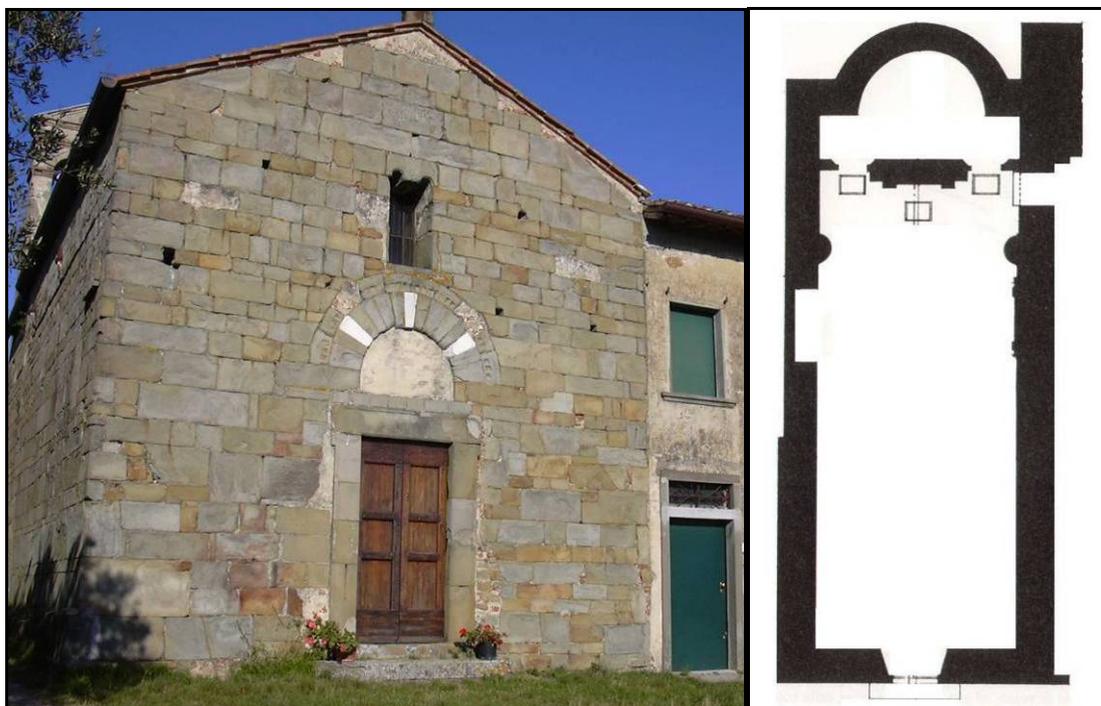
Chiesa di San Jacopo a Pulignano: facciata e pianta
